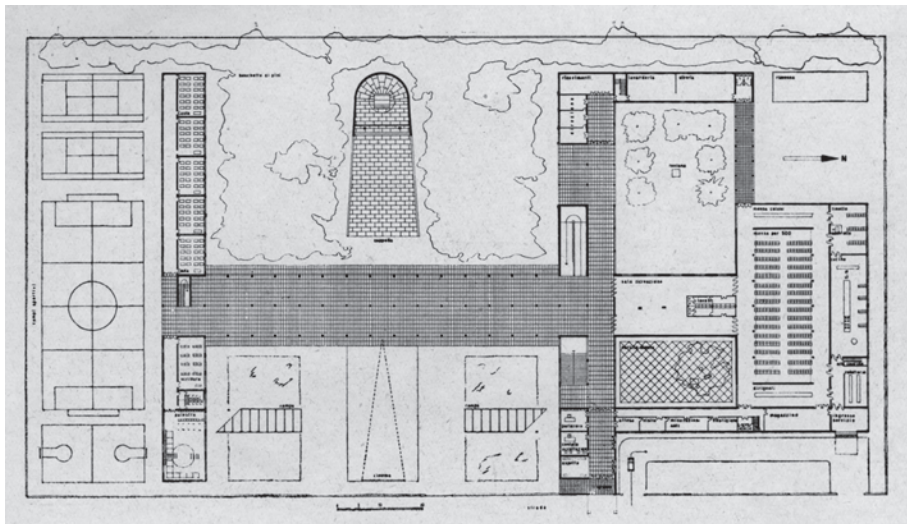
Eugenio Montuori, Entwurf (1.Preis) im Rahmen des Wettbewerbs zur Errichtung einer Ferienkolonie des Unternehmens Montecatini bei Marina di Ravenna 1936: Grundriss EG
